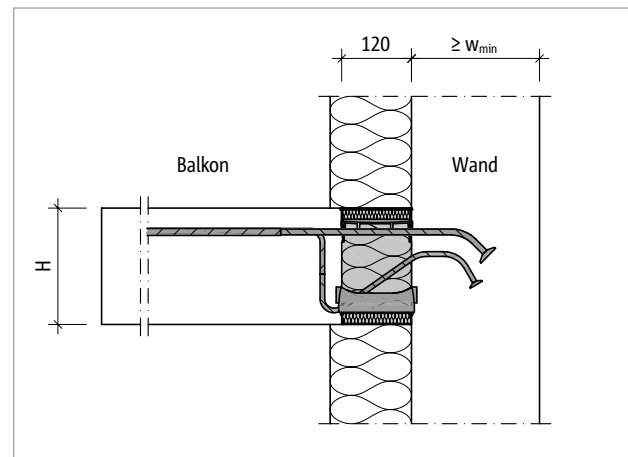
Schöck Isokorb® XT Typ KL-O: Wandanschluss nach unten bei Au-ßendämmung
